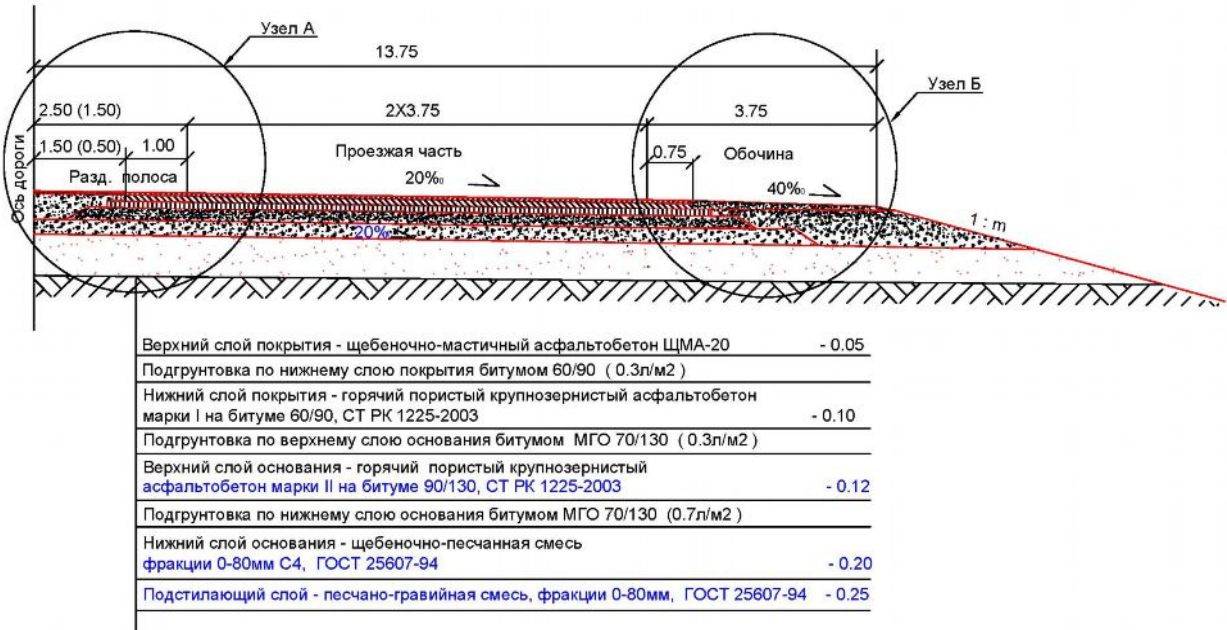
Конструкция дорожной одежды на супесчаных грунтах под нагрузку А13
